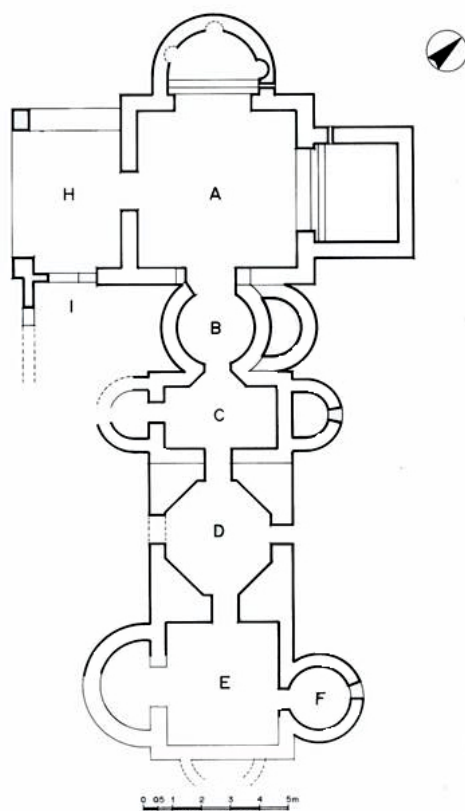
San Salvatore, Terme di Domu y Cubas; planimetría (de Donati, Zucca 1992)
